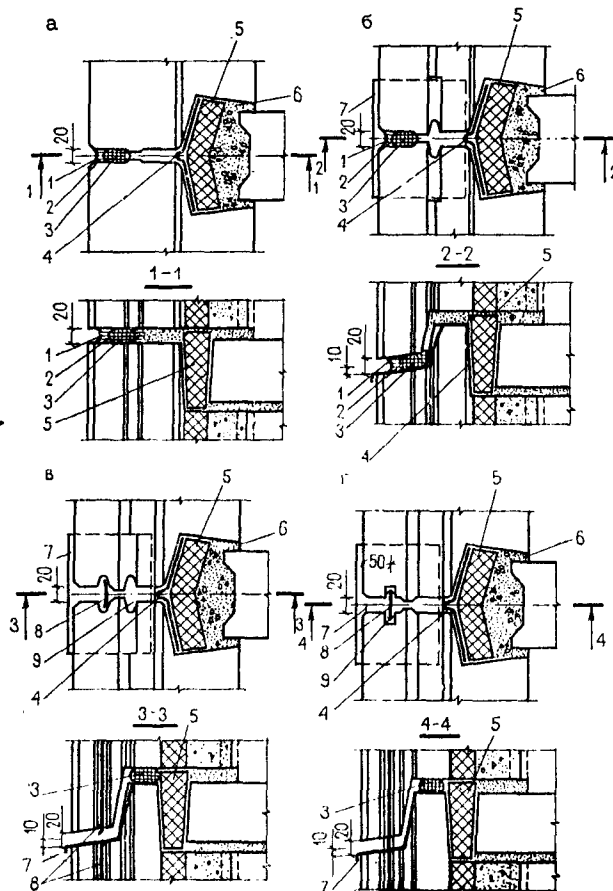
Изоляция рядовых стыков панелей наружных стен
